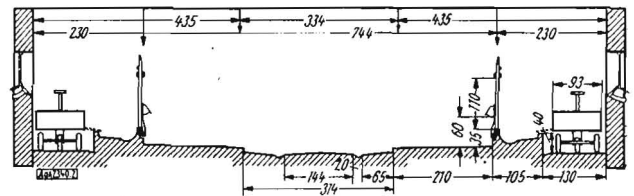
Stallquerschnitt eines Typenstalles mit Fütterung durch handgezogenen Dreiradkarren. Stallbreite 12,04 m
